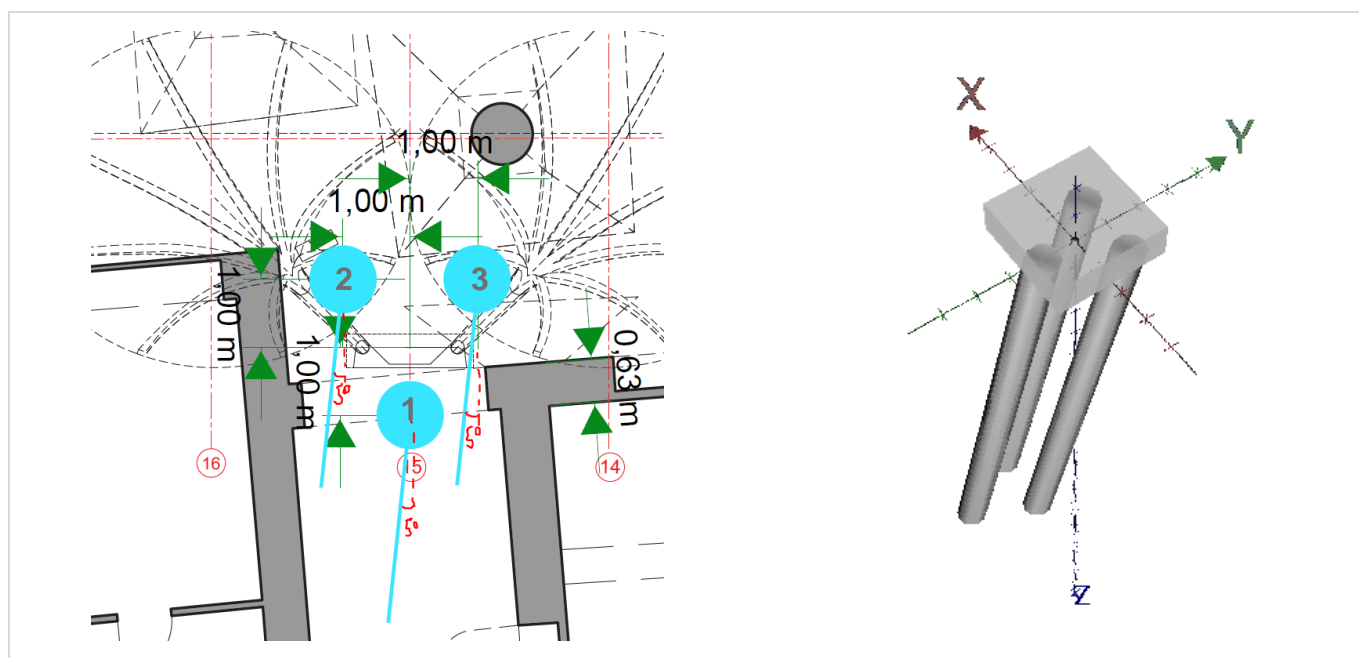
Calepinage des colonnes de jet grouting et modèle de la fondation des poteaux inclinés 1007 + 1008
